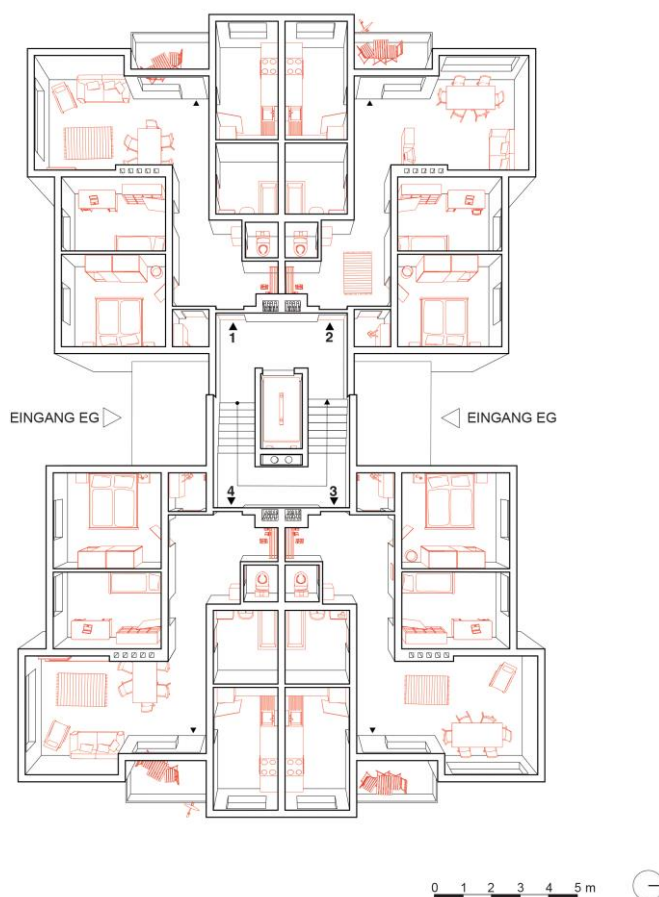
Grundriss Regelgeschoss Bestand
